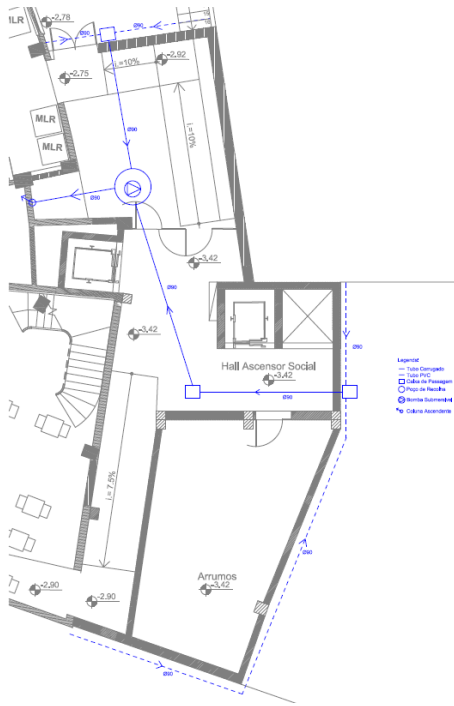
Traçado da rede periférica e execução de poço drenante
